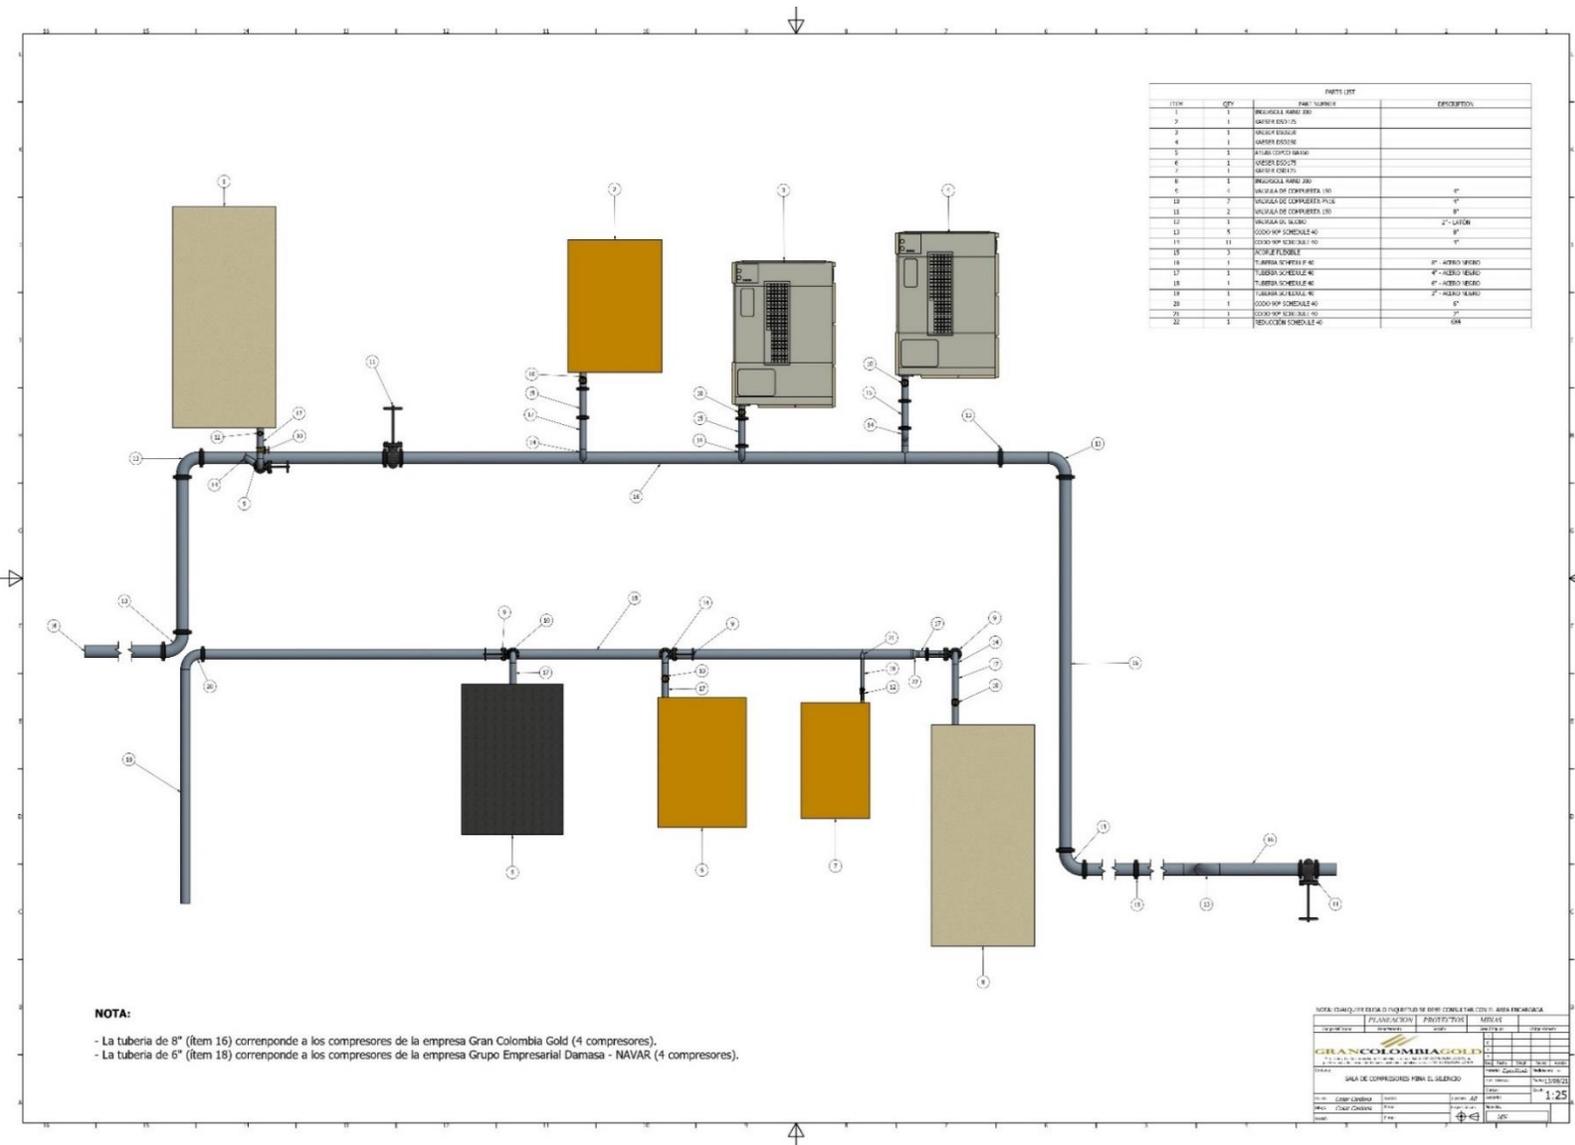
Levantamiento de detalle Sala compresores mina El Silencio
